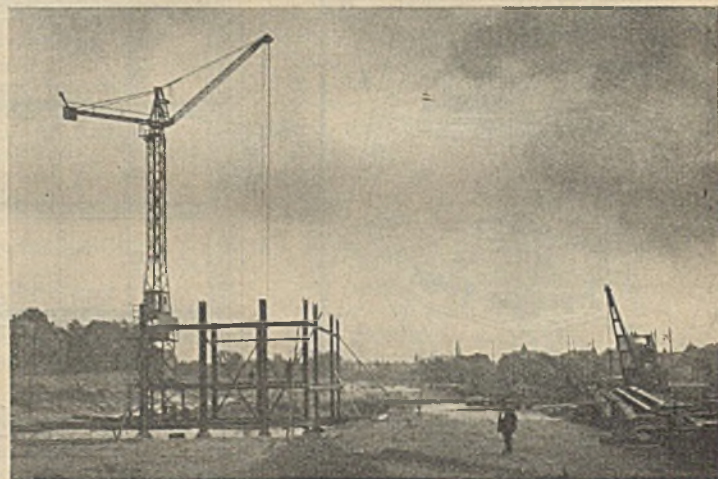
Montage mit Hilfe des Turmdrehkranes.
